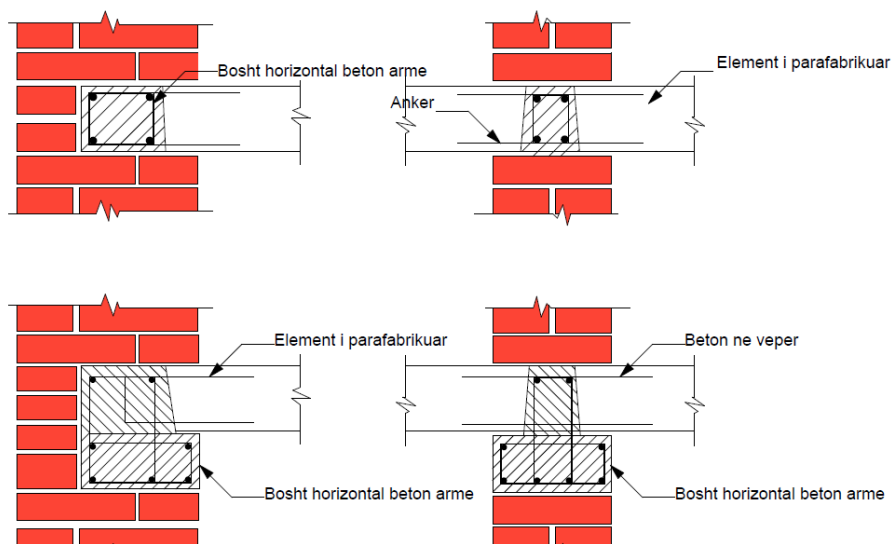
Forma të ankerimeve me tipe të ndryshme të pllakave
